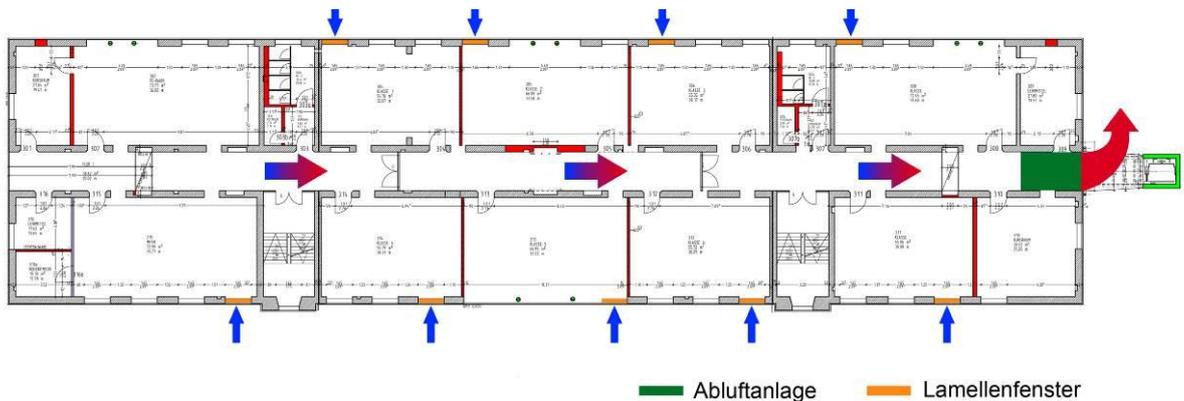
Grundriss des zweiten Obergeschosses der Oststadtschule mit dem Luftwegeschema und den Klassenräumen, die mit Klappfenstern ausgerüstet wurden.
